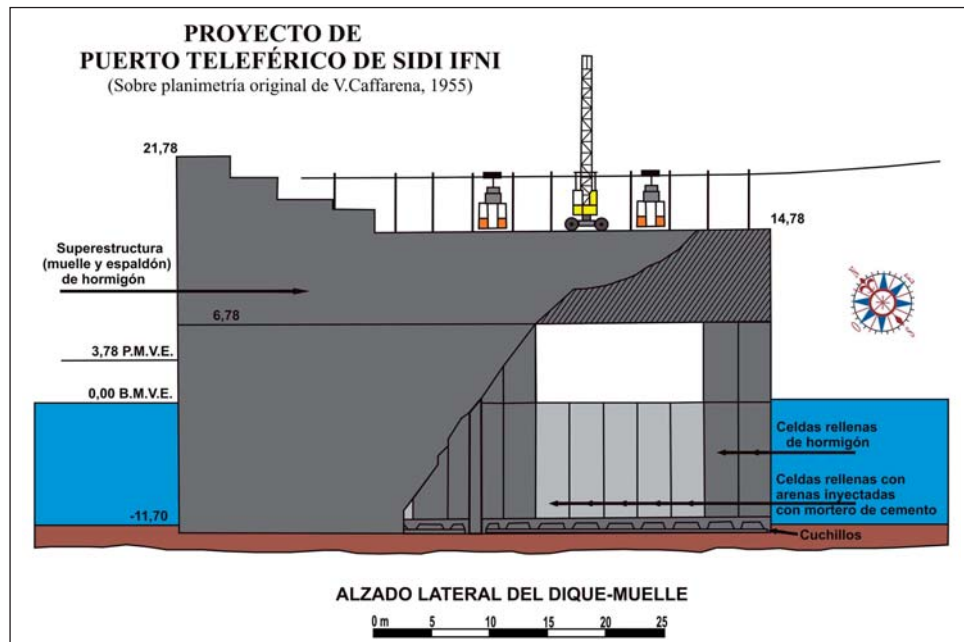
Plano del alzado lateral del dique muelle proyectado con la composición interna, la grúa sobre raíles y el teleférico convencional (sobre planimetría original, CAFFARENA 1955:110).
